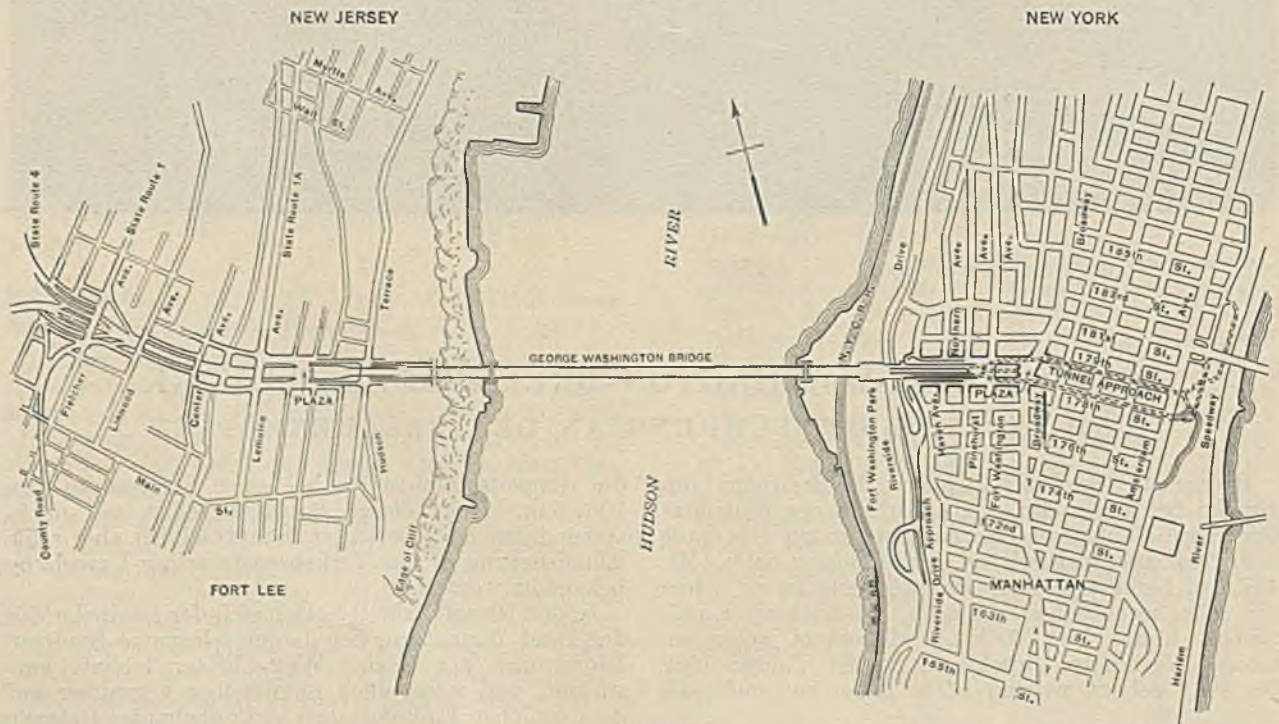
Lageplan der Brücke zwischen Newyork und Newjersey.
